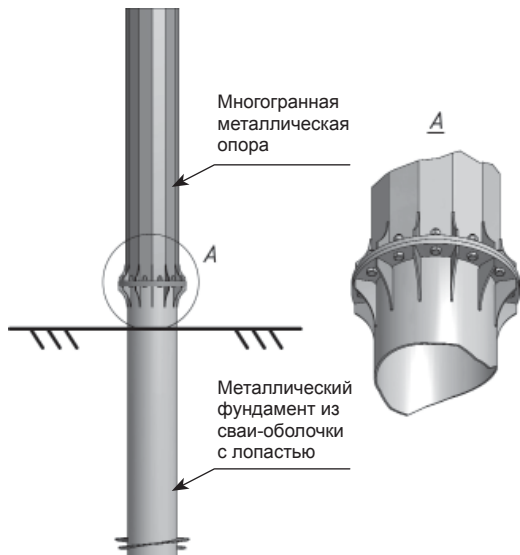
Схема фундамента из сваи-оболочки трубчатого сечения, снабженного винтовыми лопастями
